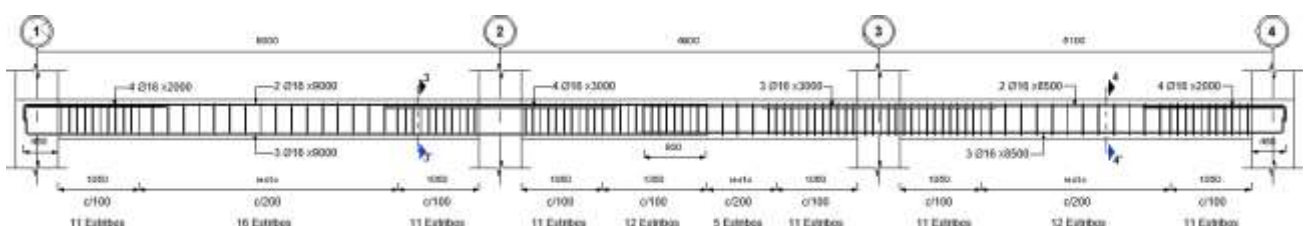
Vista longitudinal de la viga. [Elaboración propia]
